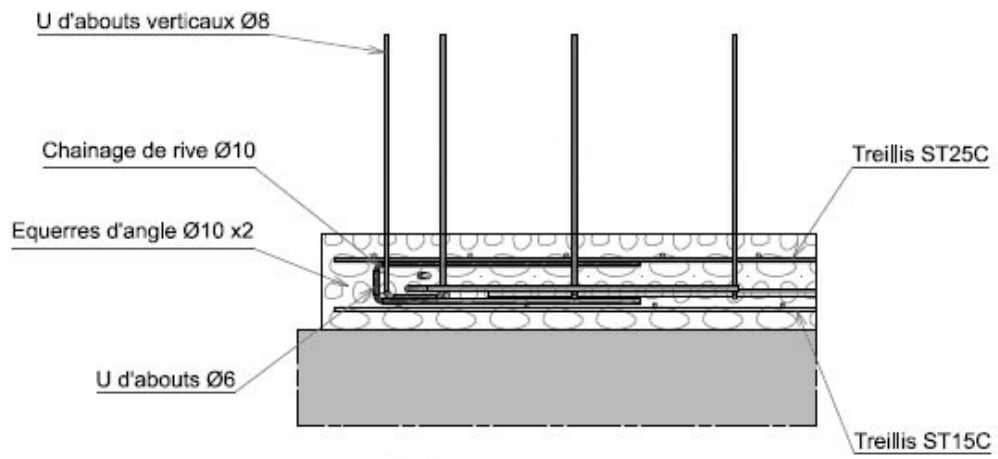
Coupe du ferrailage du radier et des armatures en attente
